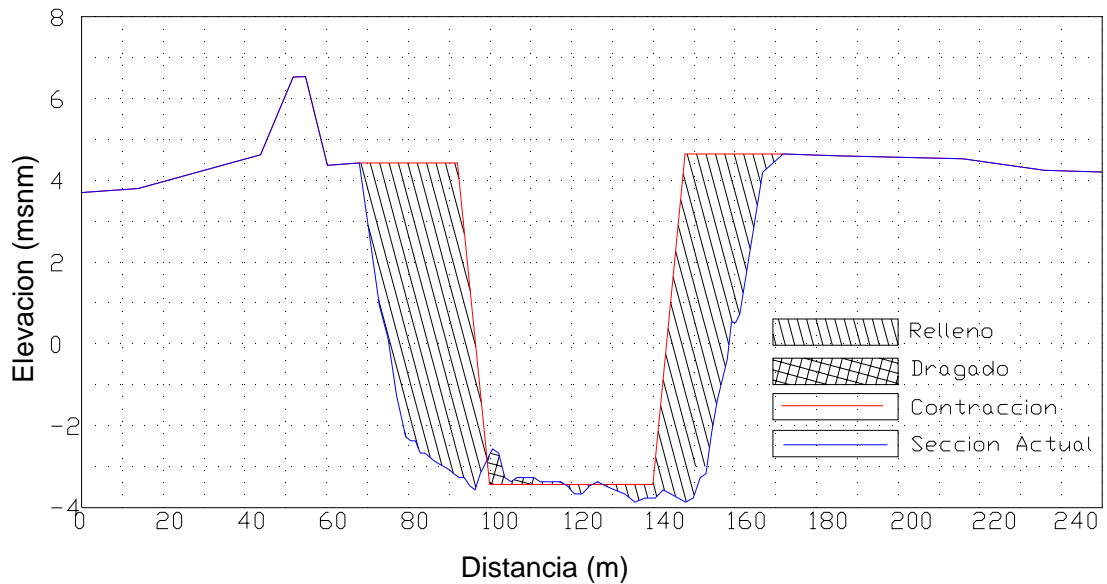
Sección transversal km 44 - Contracción No. 2
